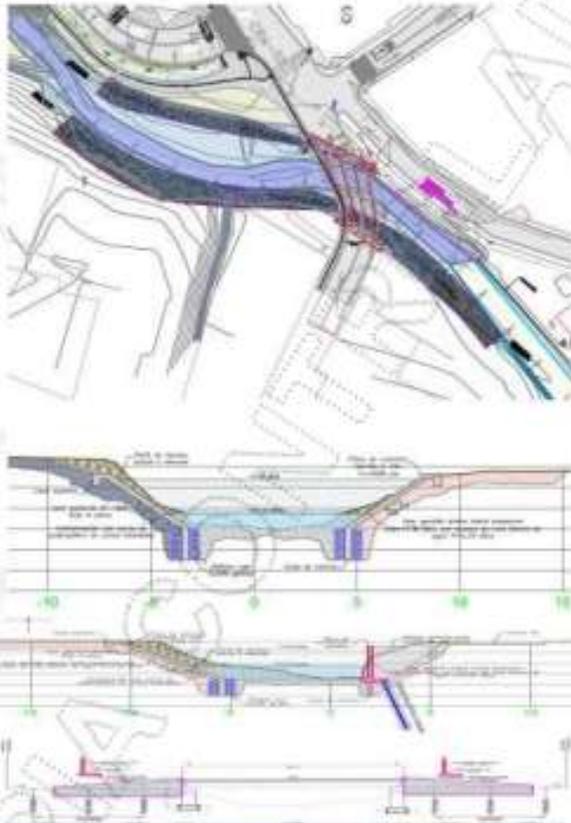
Tipo de la Obra:		Protección lateral de la quebrada puente calle 52
